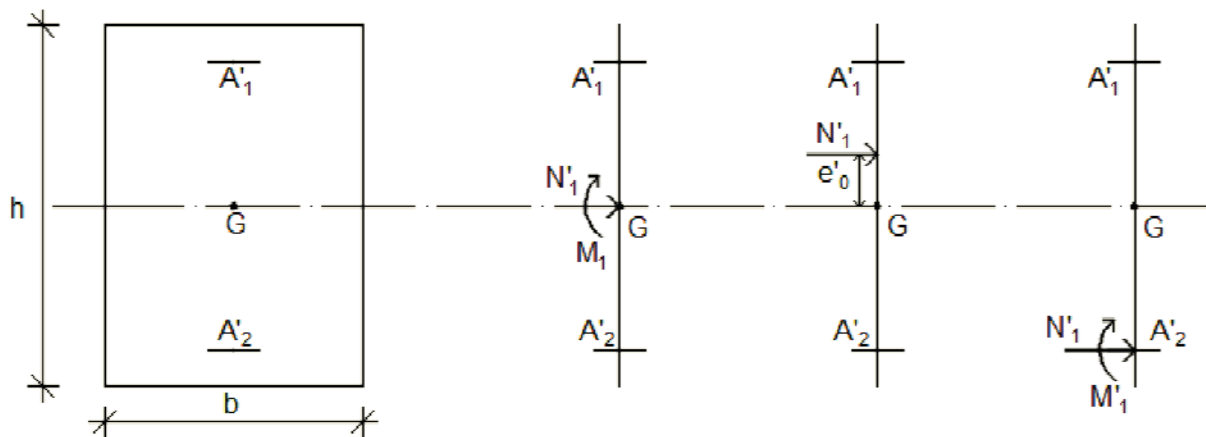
Position de N'_1 M'_1 et M_1 sur la section transversale.
